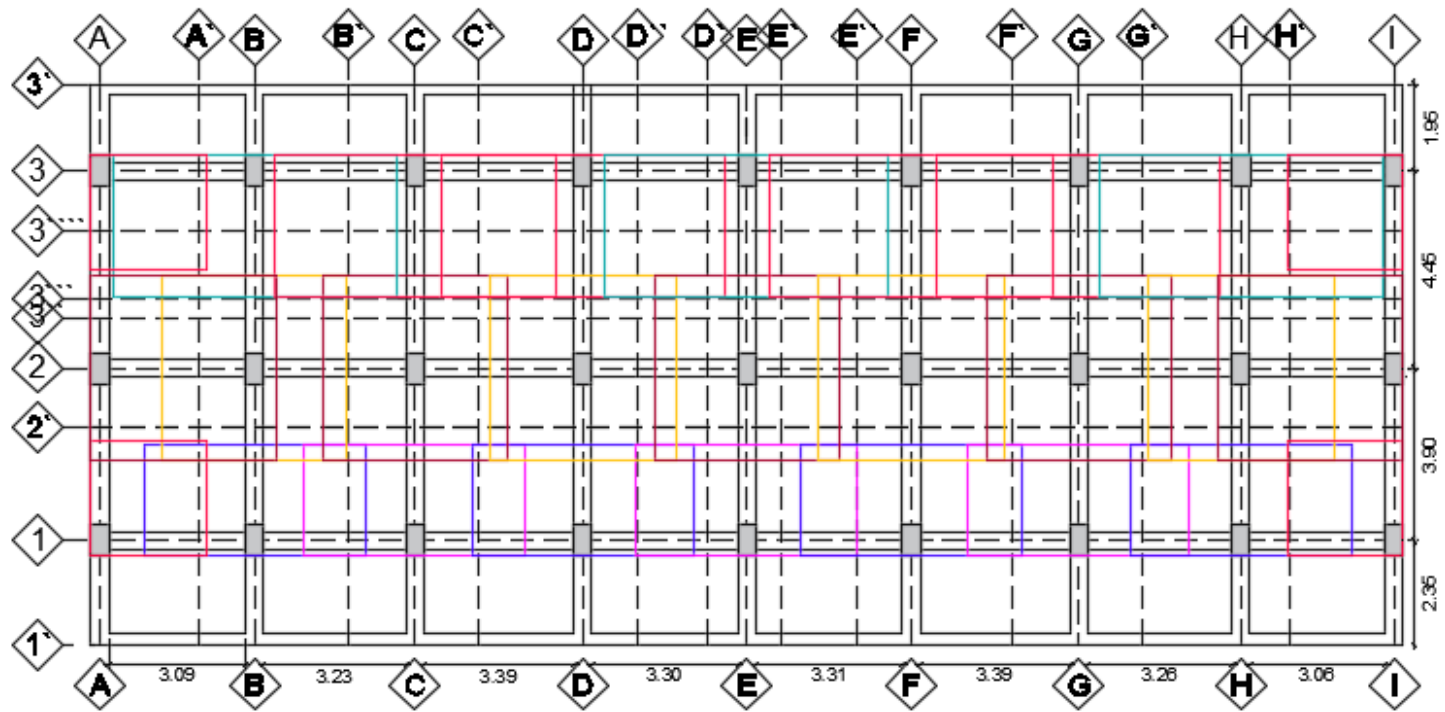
Representación de distribución de zapatas en la estructura aligerada con bloques de poliestireno.
